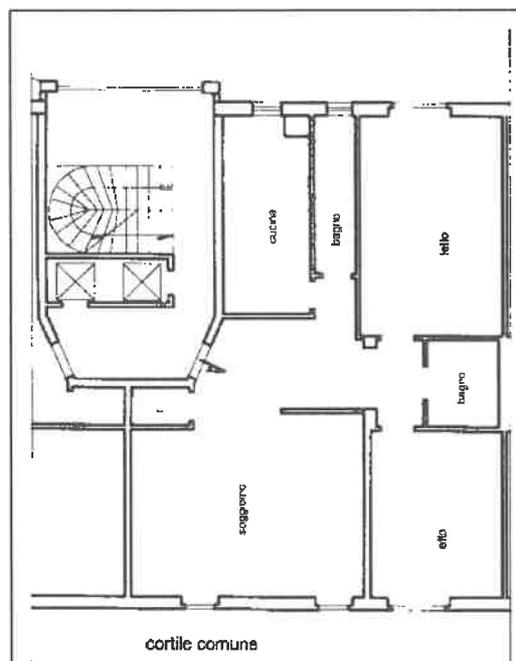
Planimetria catastale presentata l'1.02.2002
